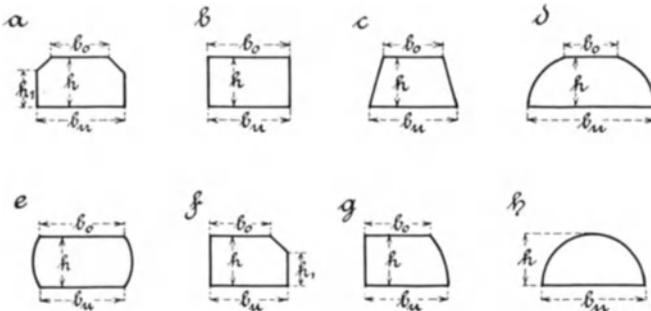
Gebräuchliche Querschnittsformen der Holzschwelle.
